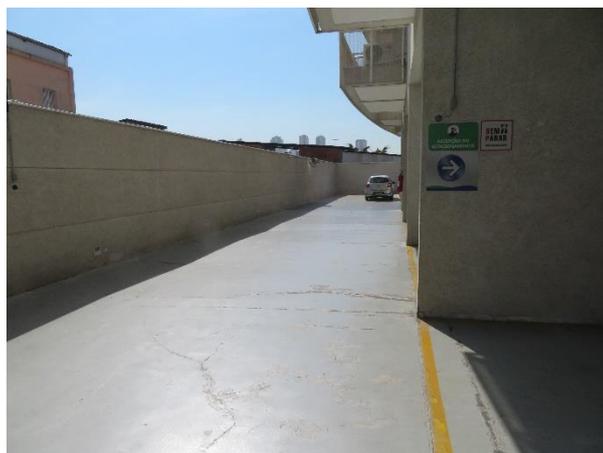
Pavimento térreo – Vagas de garagem com manobrista.
